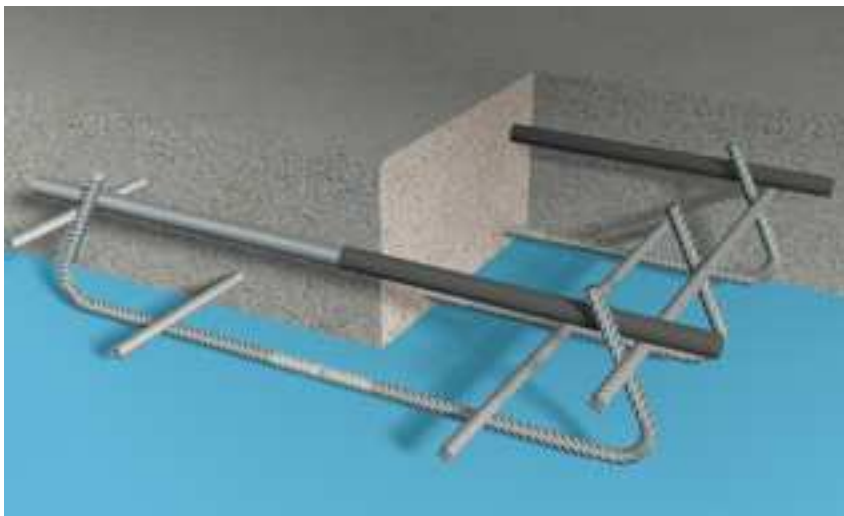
exemplo de conetores em gaiola num pavimento
